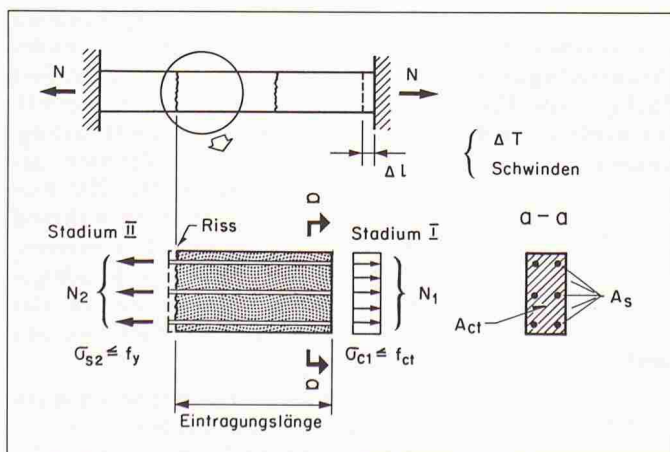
Gleichgewichtsbedingung unter der Risslast in einem Stahlbetonzugband
